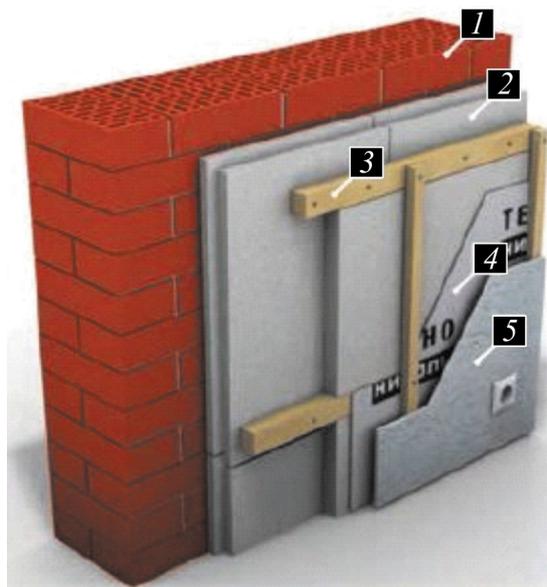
Схема утепления стены изнутри: 1 – несущая стена; 2 – утеплитель; 3 – прижимные рейки из дерева; 4 – пароизоляционная пленка; 5 – внутренняя отделка помещения
